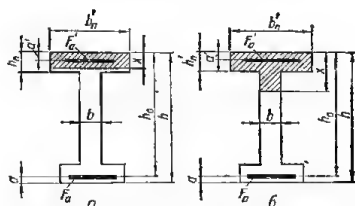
Схема сечения железобетонного элемента с полкой в сжатой зоне при расположении нейтральной оси:
